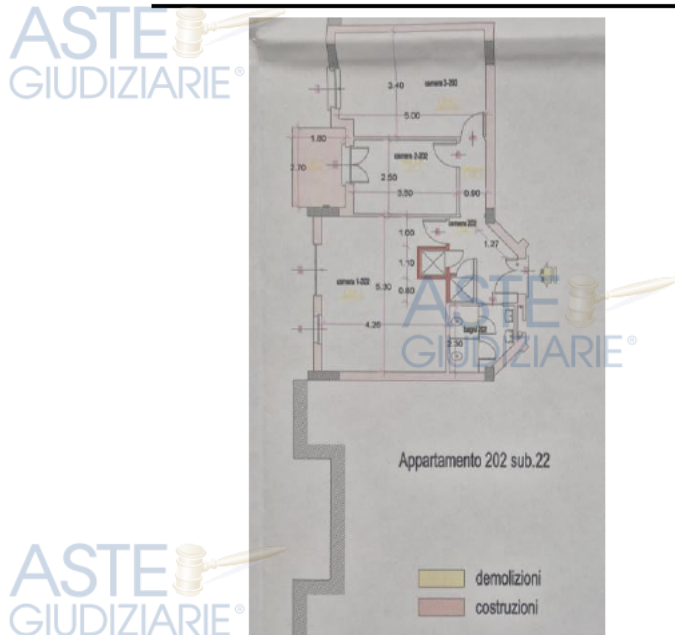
Planimetria secondo la CILA del 12/02/2018 prot. n.811 - LOTTO N.1
